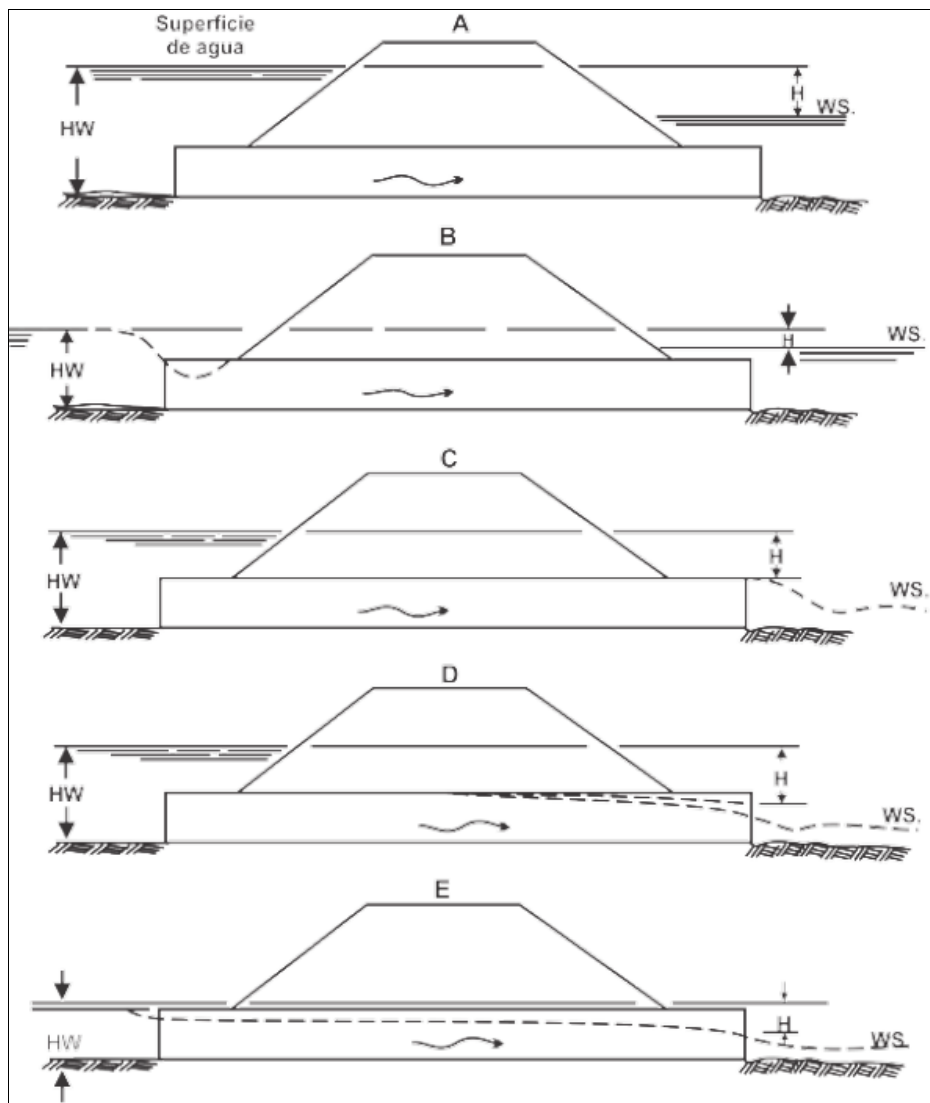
Condiciones de Flujo en Alcantarillas con Control a la Salida. Fuente: Hydraulic Design of Highway Culverts. Pub. No. FHWA-NHI-01-020. Rev. May 2005.
